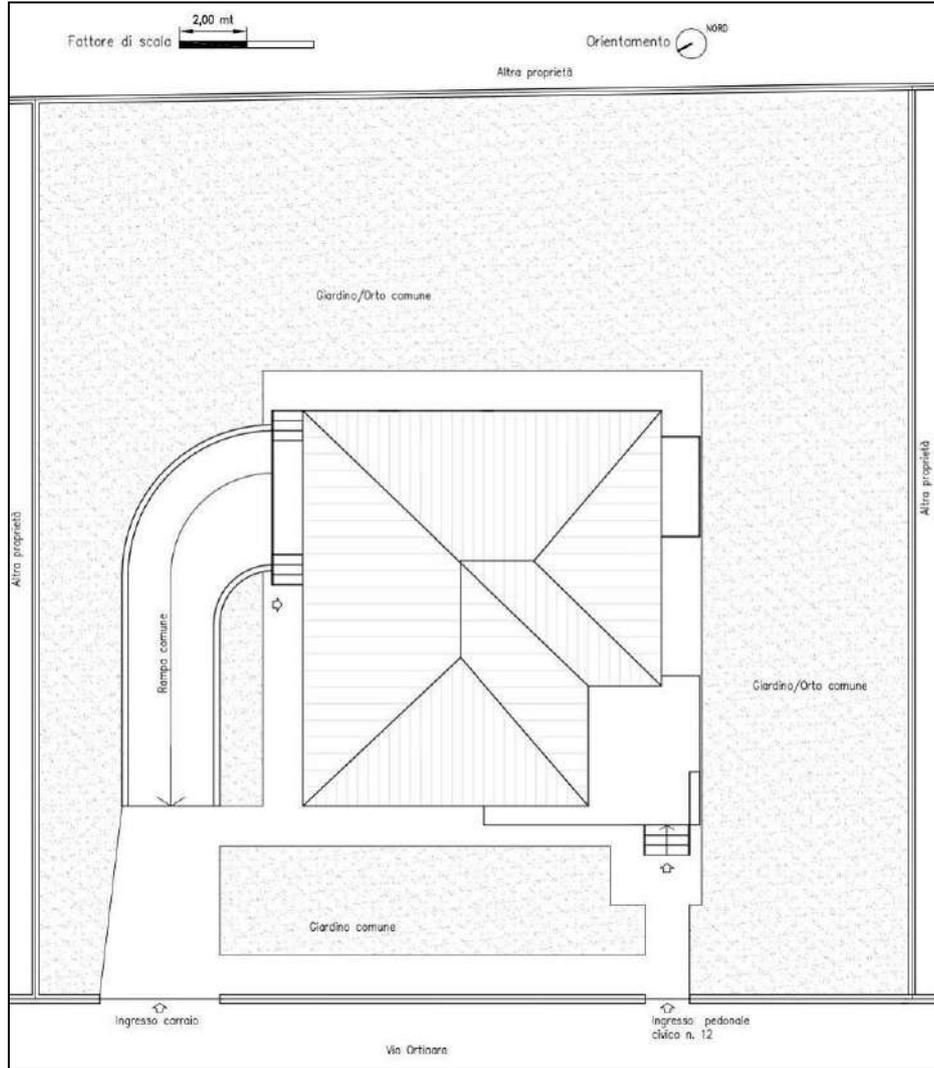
planimetria da Licenza di Costruzione n. 1289 del 04.03.1968
